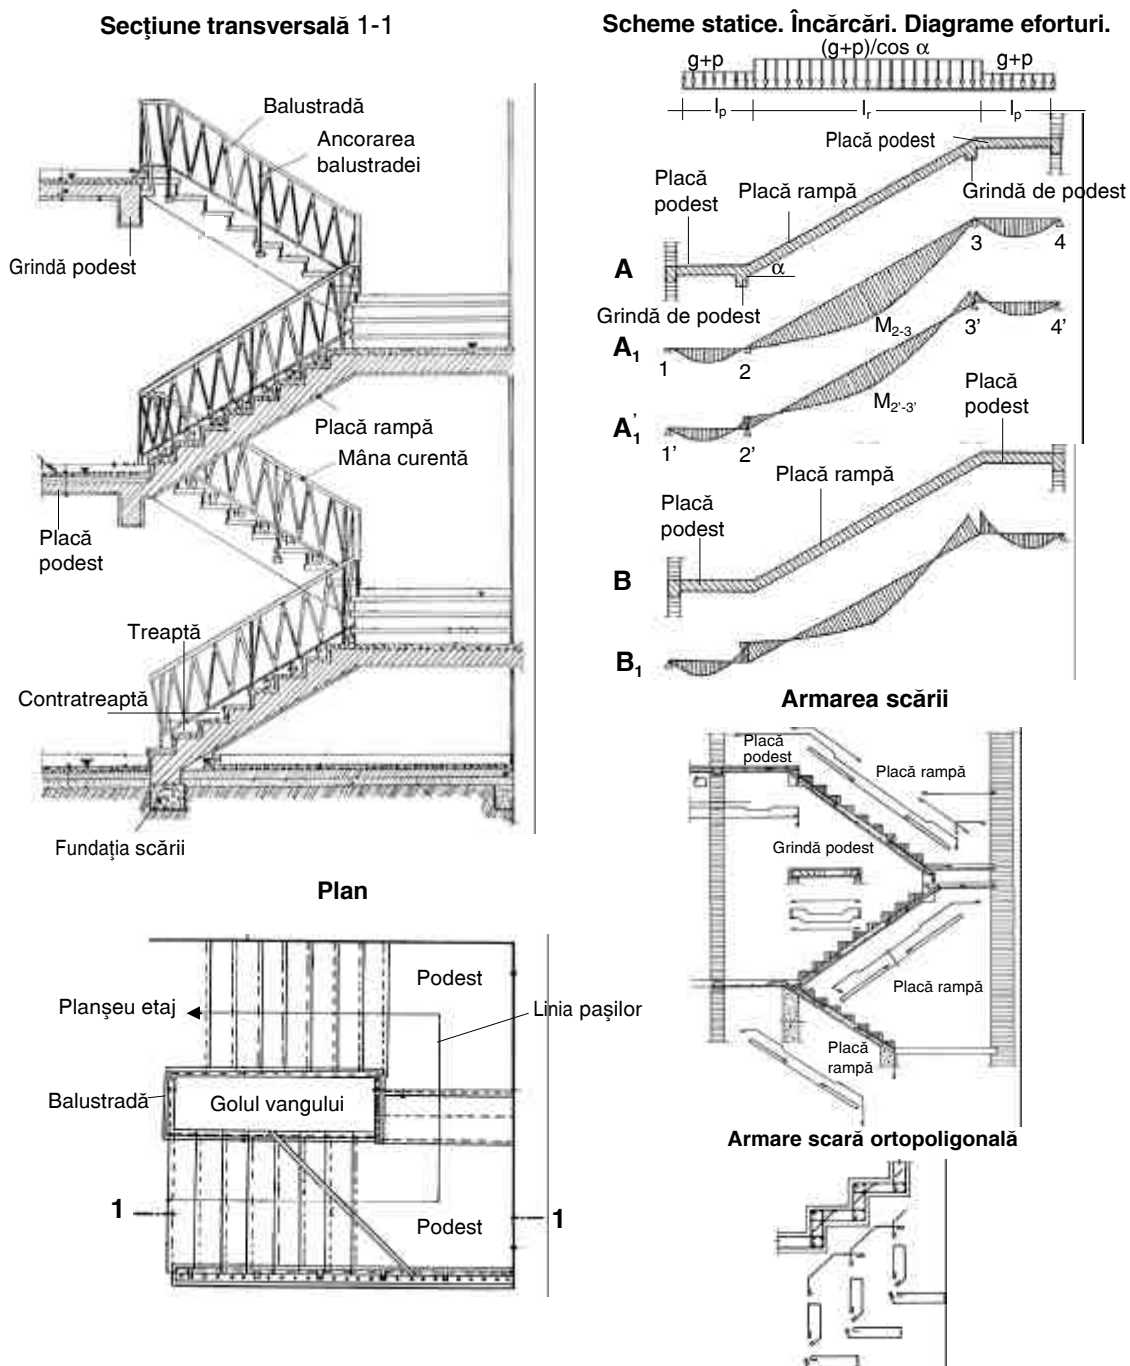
Scară din beton armat monolit. Secțiune transversală. Plan. Scheme statice. Armare.
